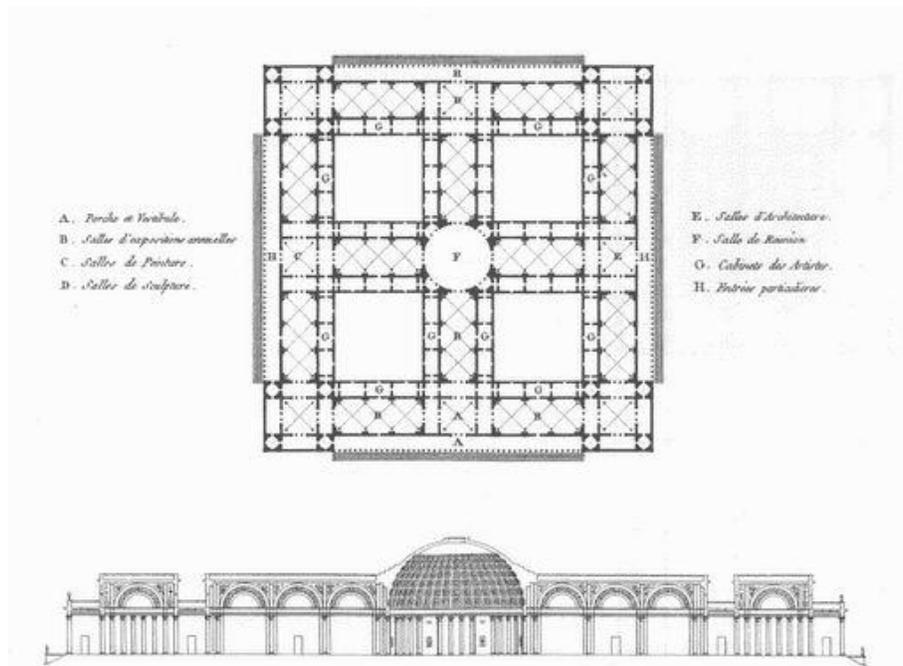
Vista en planta y vista seccional del proyecto de Durand. Se mantienen las características del museo palacio de Boullée pensando también en la interacción masiva.
